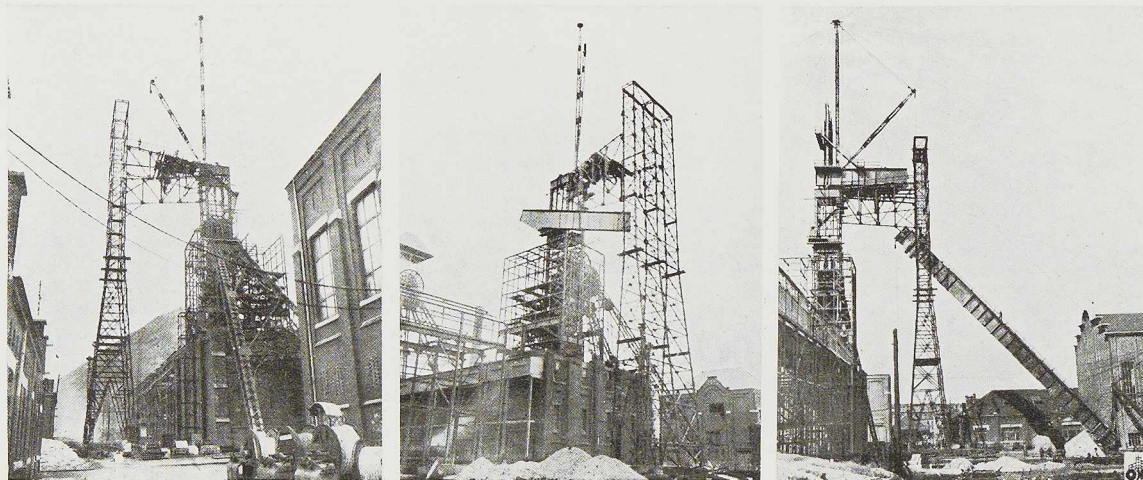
, 32, 33. Différents stades de montage. La première vue montre la tour conduite à une hauteur de 48 mètres. Les deux autres montrent le levage d'un des coudes au moyen d'un derrick et l'amenée du pied du poussard à côté du massif de gauche.
